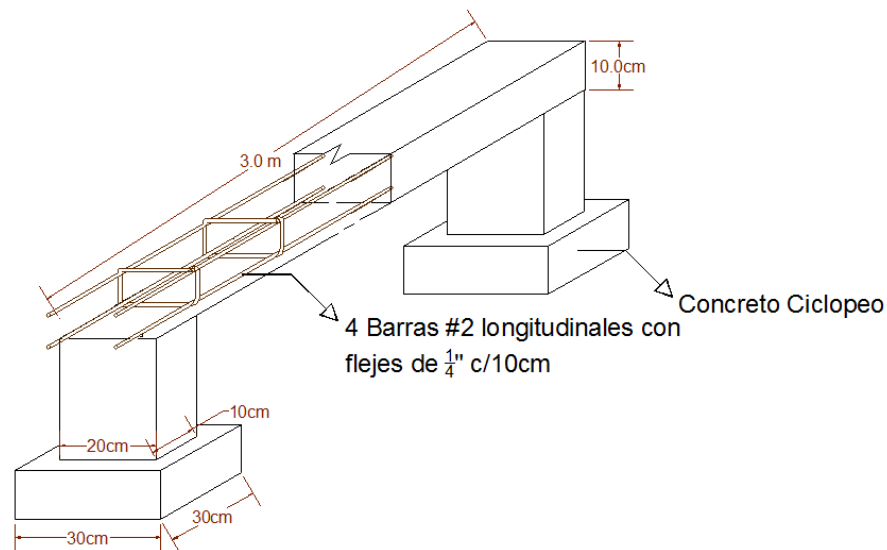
Distribución de las varillas de viga de soporte del semiencofrado.
